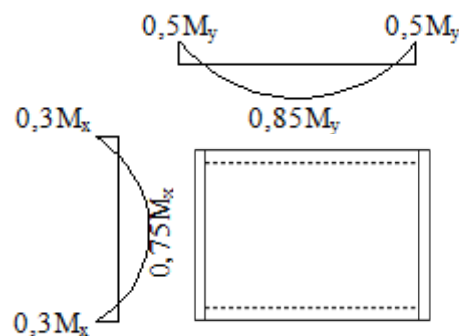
Schéma du panneau de la dalle appuyée sur 4 coté.
